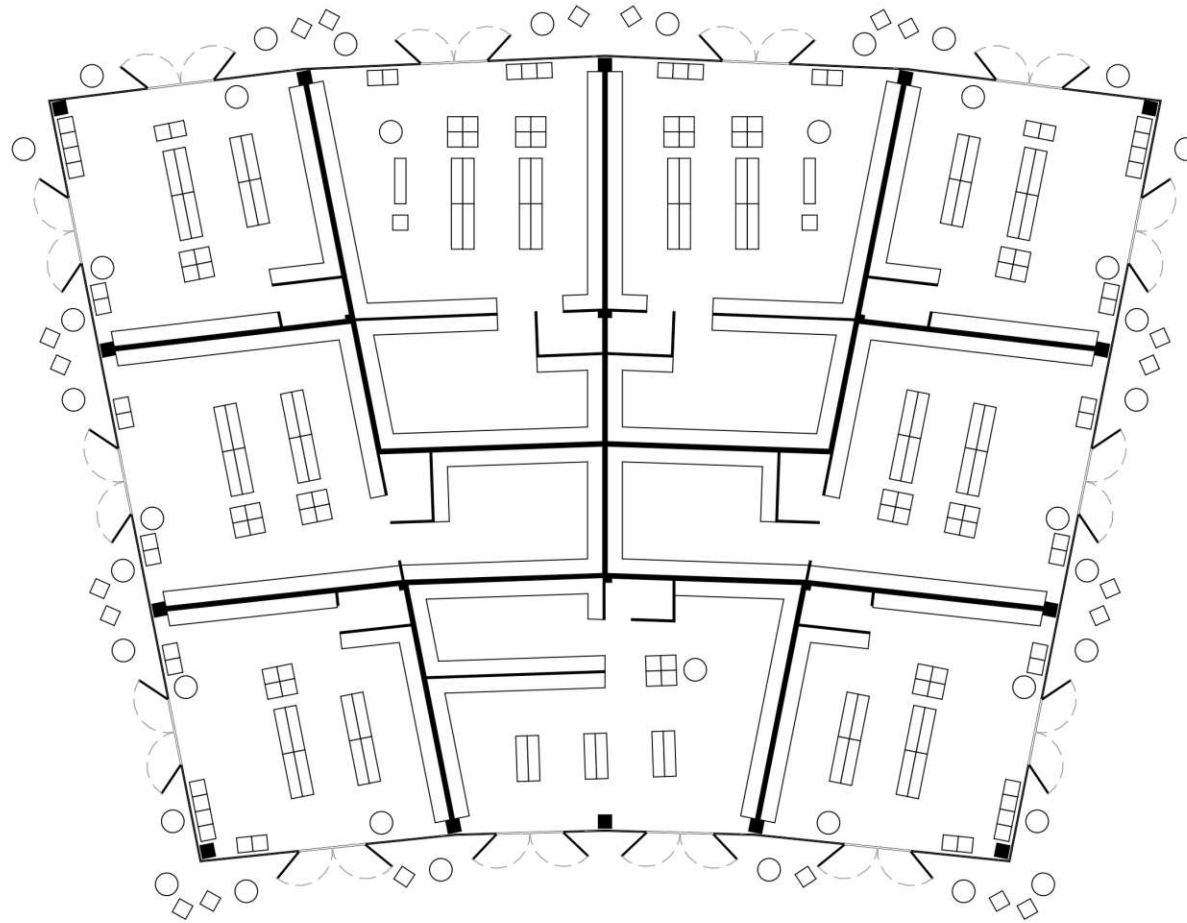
| Grundriss einer Halle mit Geschäften
